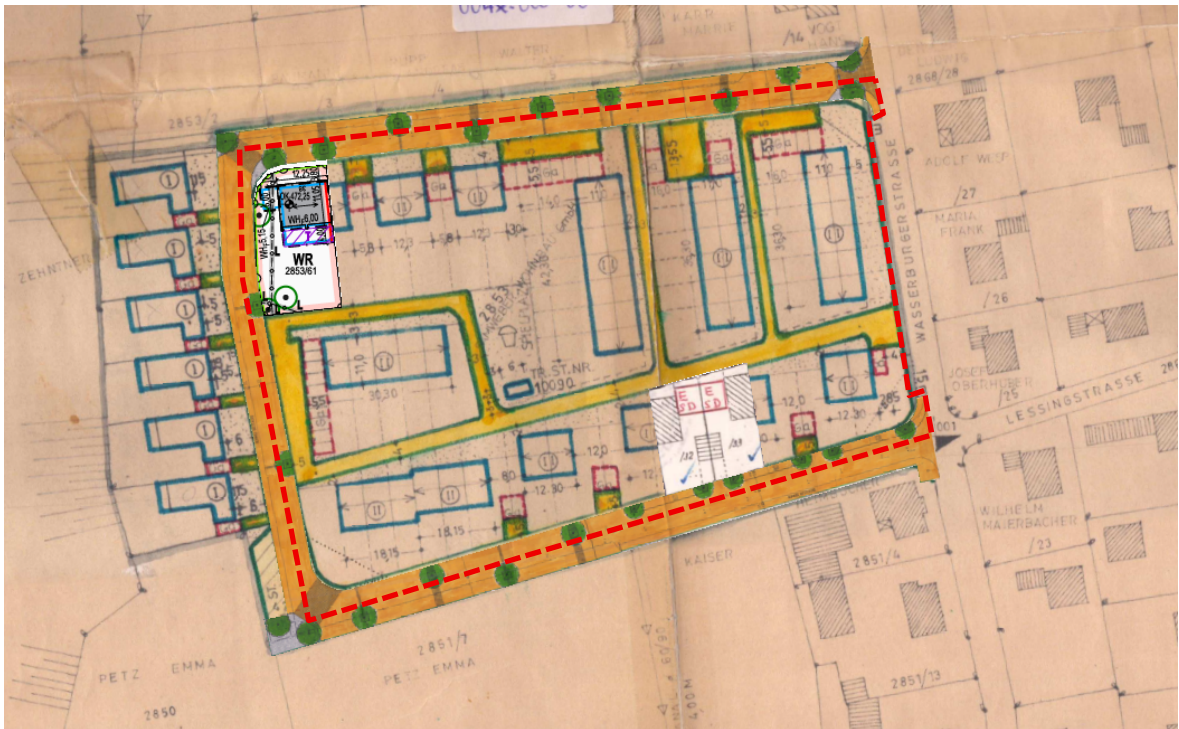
Ausschnitt Ur-Bebauungsplan Nr. 4 mit Darstellung Änderungsbereich - rot - ohne Maßstab
